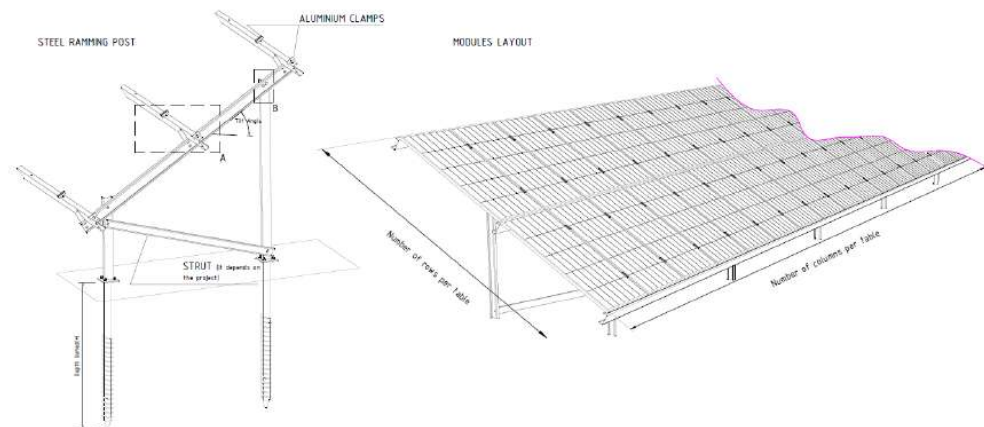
Detalle de tipo de estructura a utilizar. Fuente: propia
